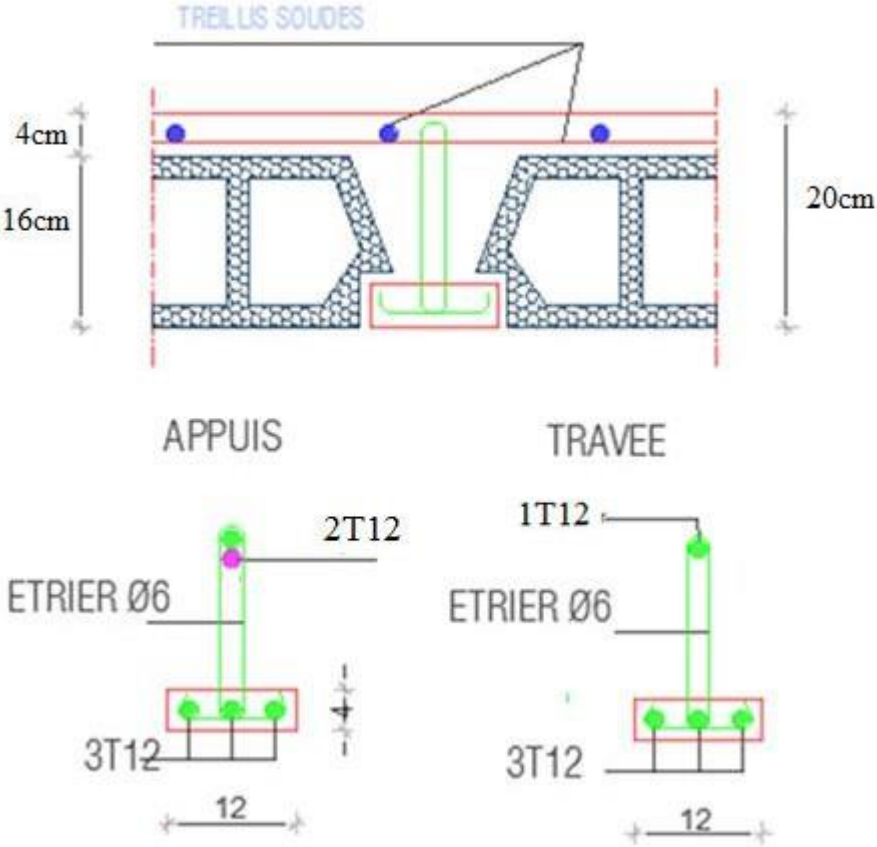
Ferrailage des poutrelles en Travée et en Appuis.
